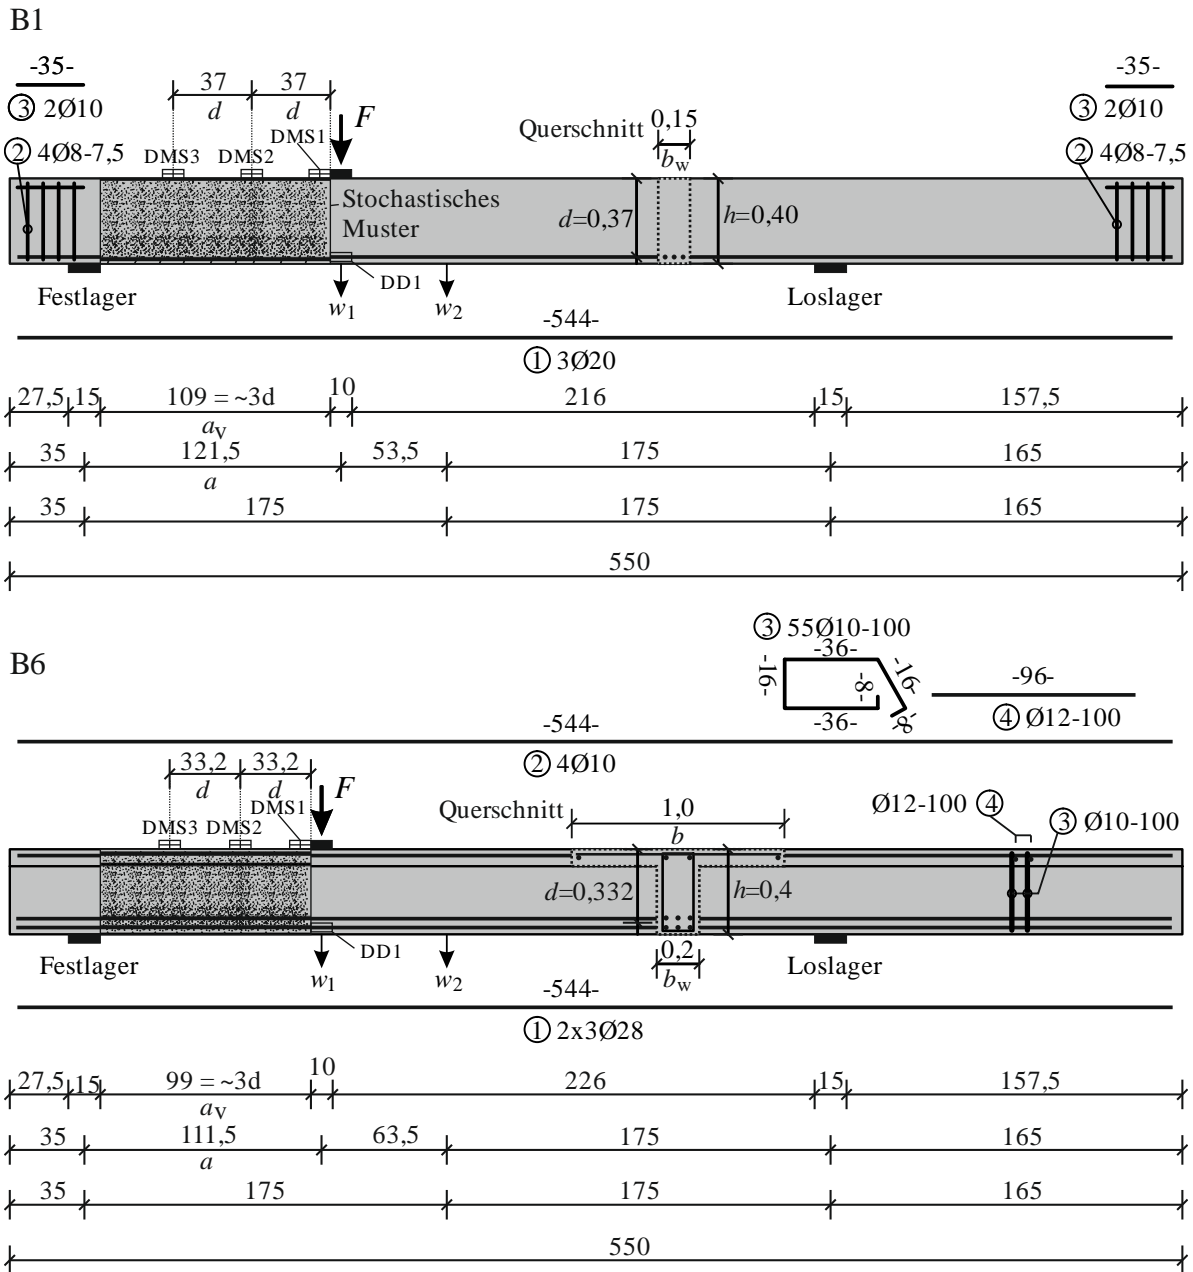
Schal- und Bewehrungsplan, Mess- und Versuchsaufbau: Rechteckbalken B1; Plattenbalken B6 [63]
